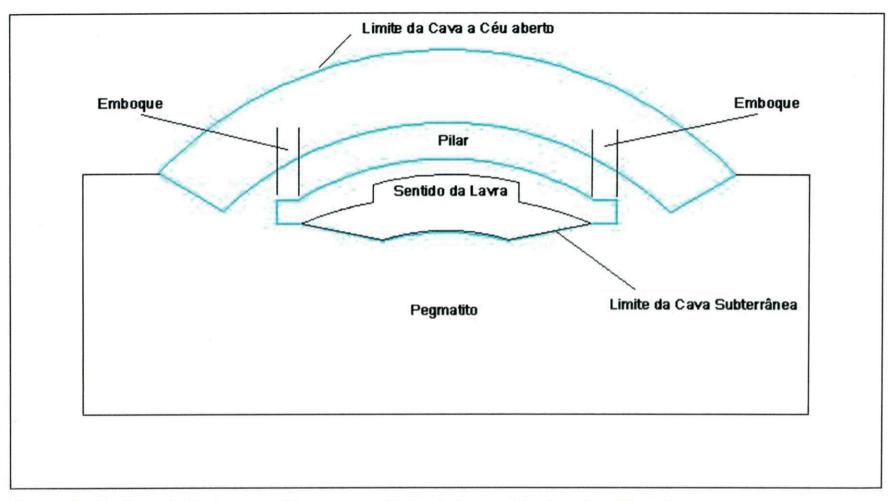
Perfil longitudinal esquemático com seqüência da lavra subterrânea (modificado)
